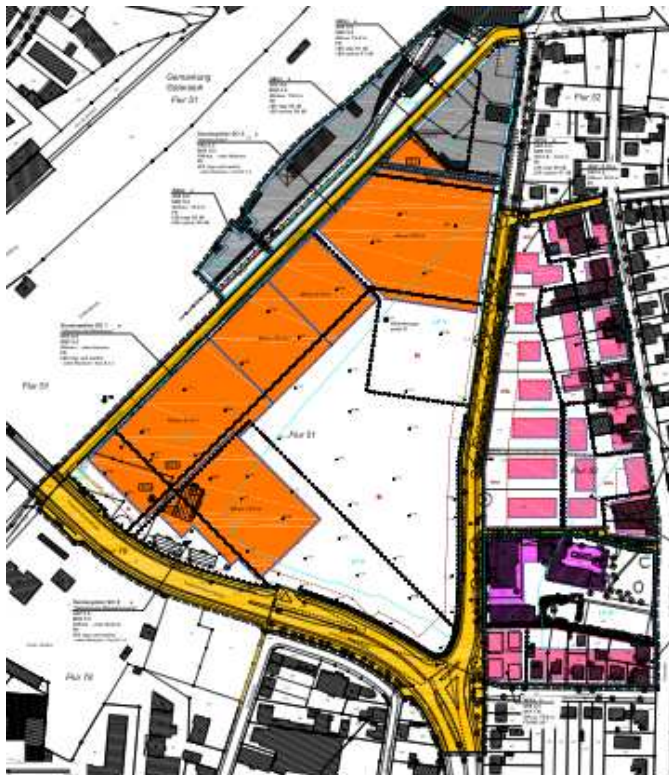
Bebauungsplan Nr. 232 „Umnutzung Areal Holzstraße“ (Quelle: verändert nach STADT GÜTERSLOH 2011b)
